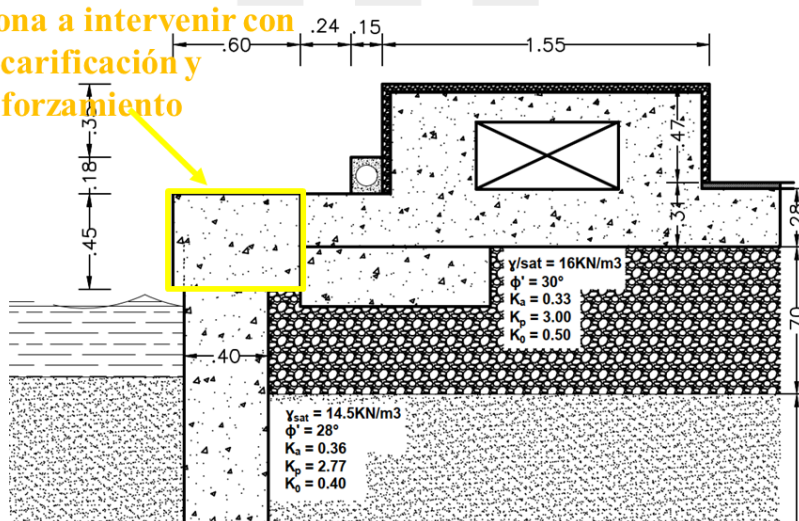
Zona a intervenir en sección transversal para reforzamiento
